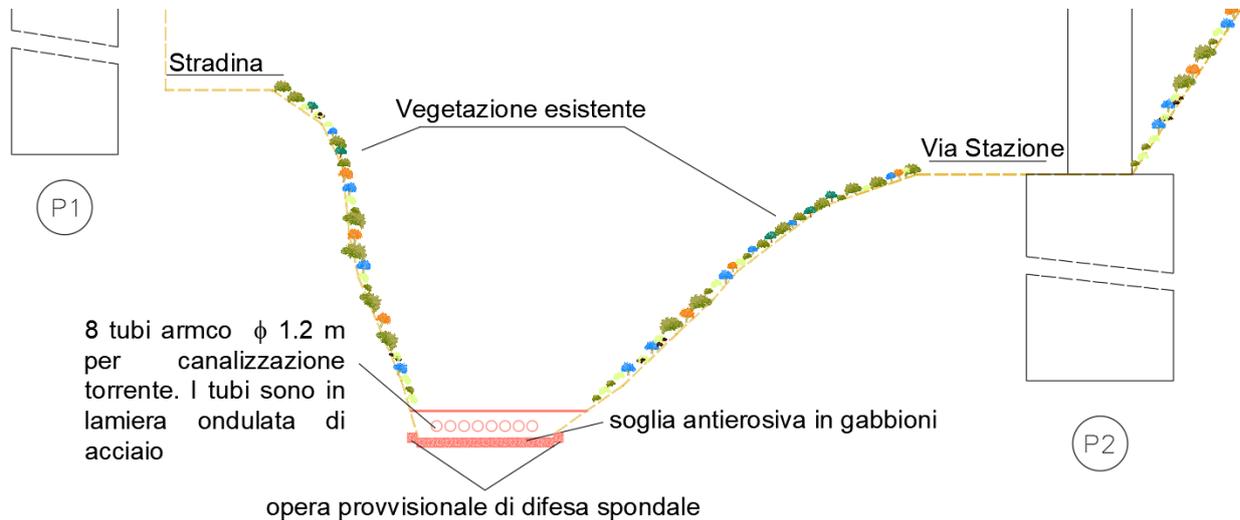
Estratto elaborato V382022002APA "Tavola della fasizzazione dell'intervento di demolizione (1 di 5)"
